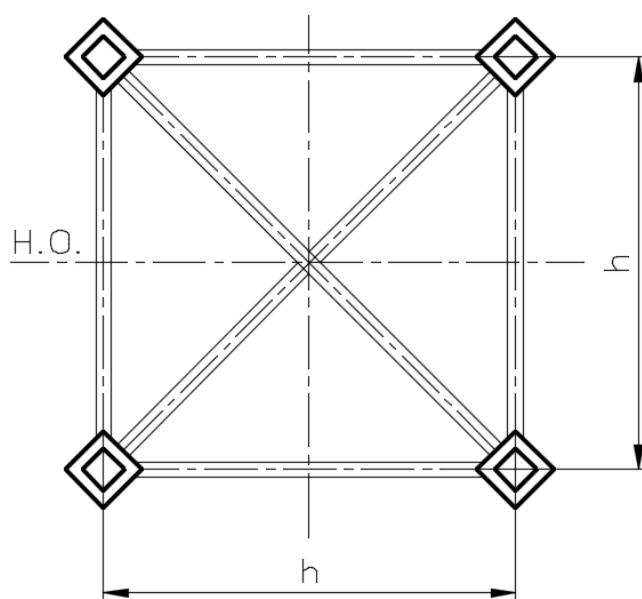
Схема поперечного сечения четырехгранной ферменной опорной колоны с рейками прямоугольного сечения A2
